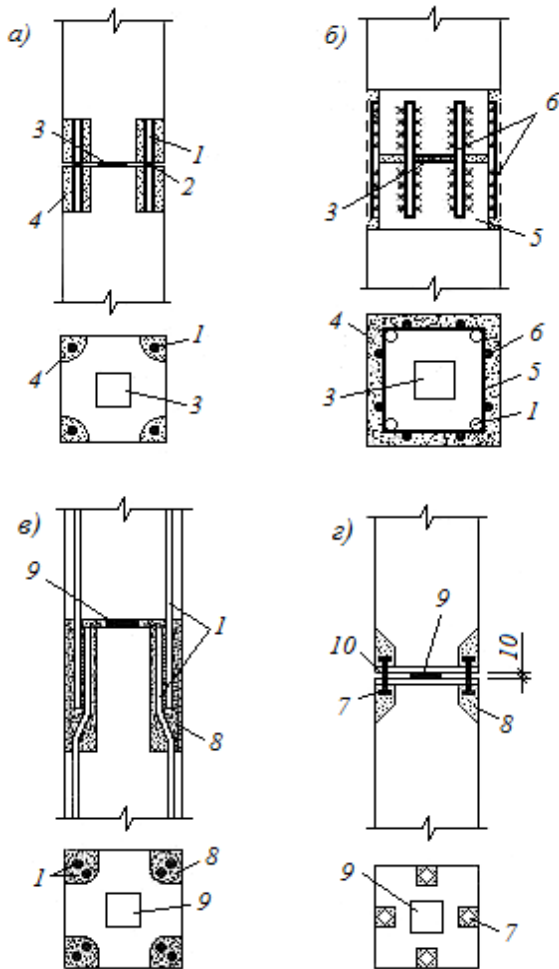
Стики колон багатоповерхових виробничих будівель: *а* – з ванним зварюванням поздовжньої арматури; *б* – зі зварюванням сталевих оголовоків; *в* – на полімерних розчинах; *г* – болтові; *1* – поздовжня арматура; *2* – ванне зварювання; *3* – сталева центрувальна пластина; *4* – дрібнозернистий бетон; *5* – сталевий оголовок; *6* – стикувальні стержні; *7* – болти; *8* – полімерний розчин; *9* – цементний (полімерний) розчин; *10* – опорна пластина
